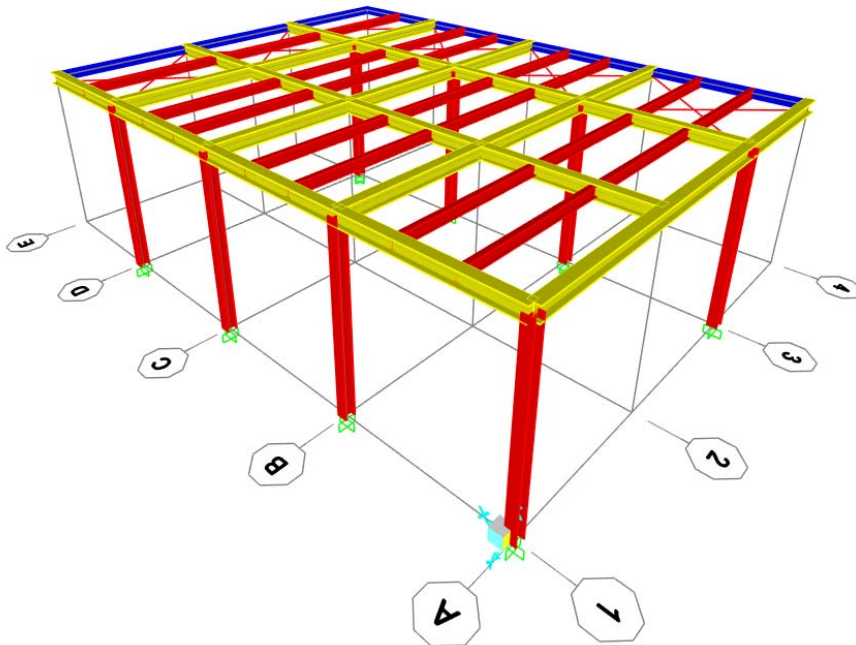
Vista assometrica modello struttura in elevazione - elementi estrusi
